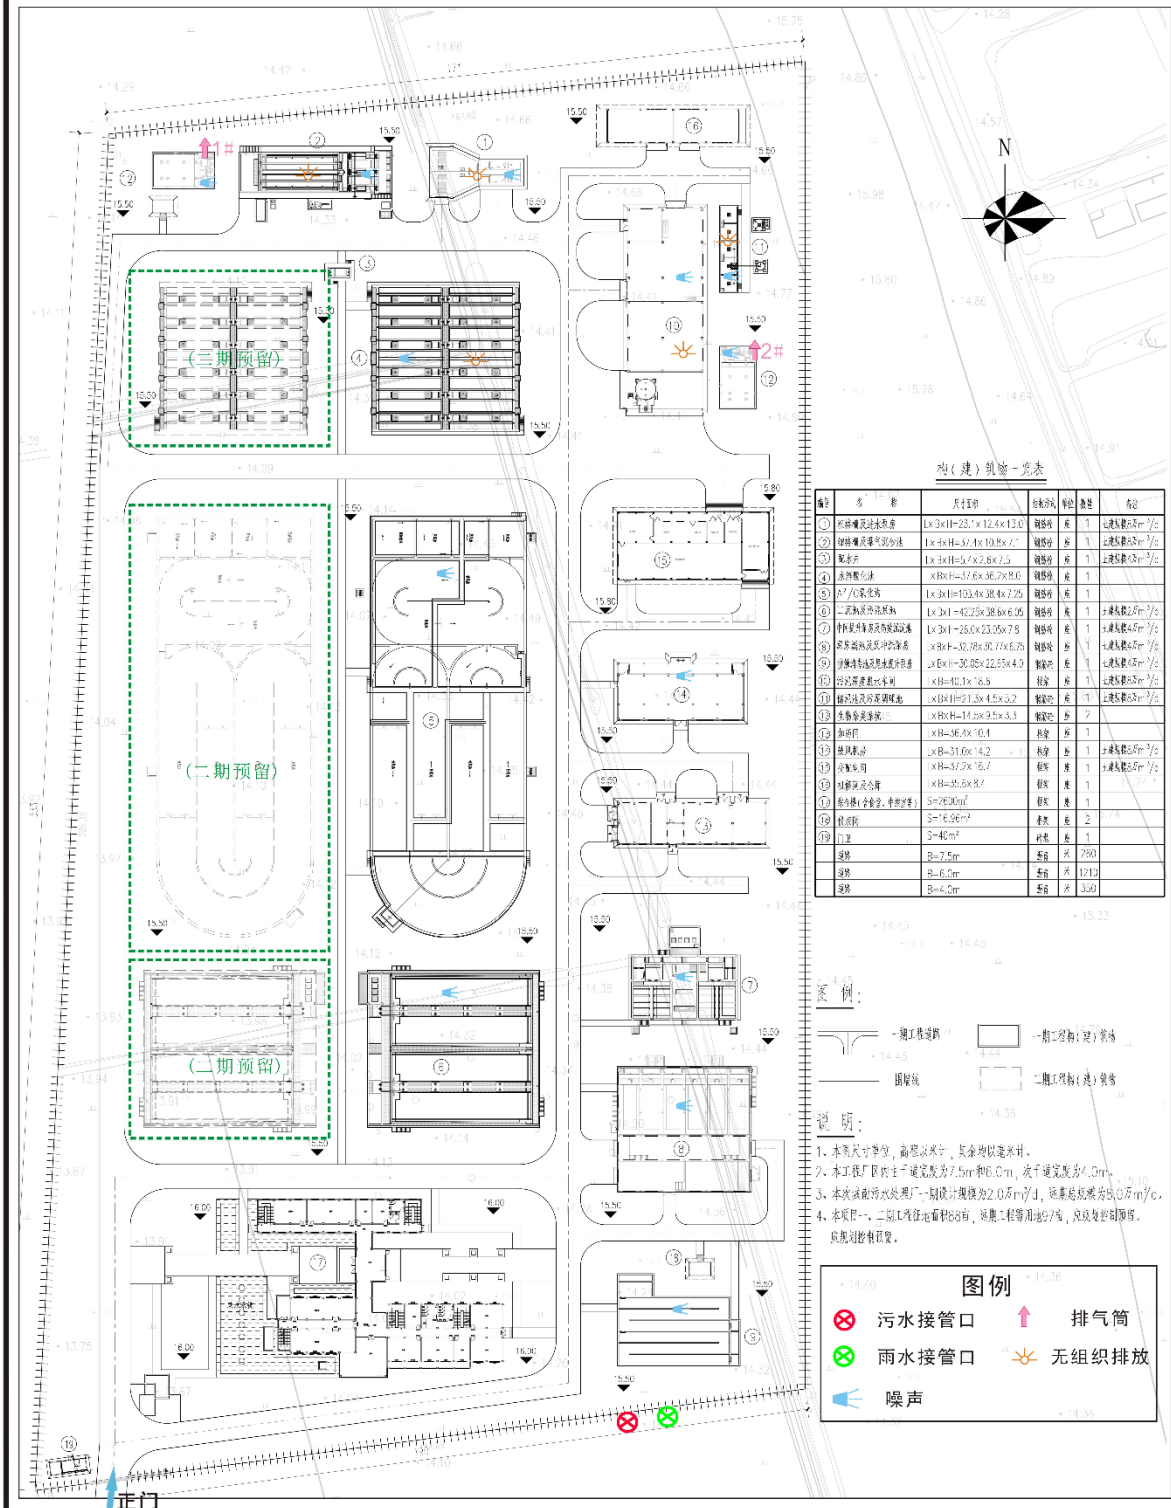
五河县城南污水处理厂一期工程平面布置图
